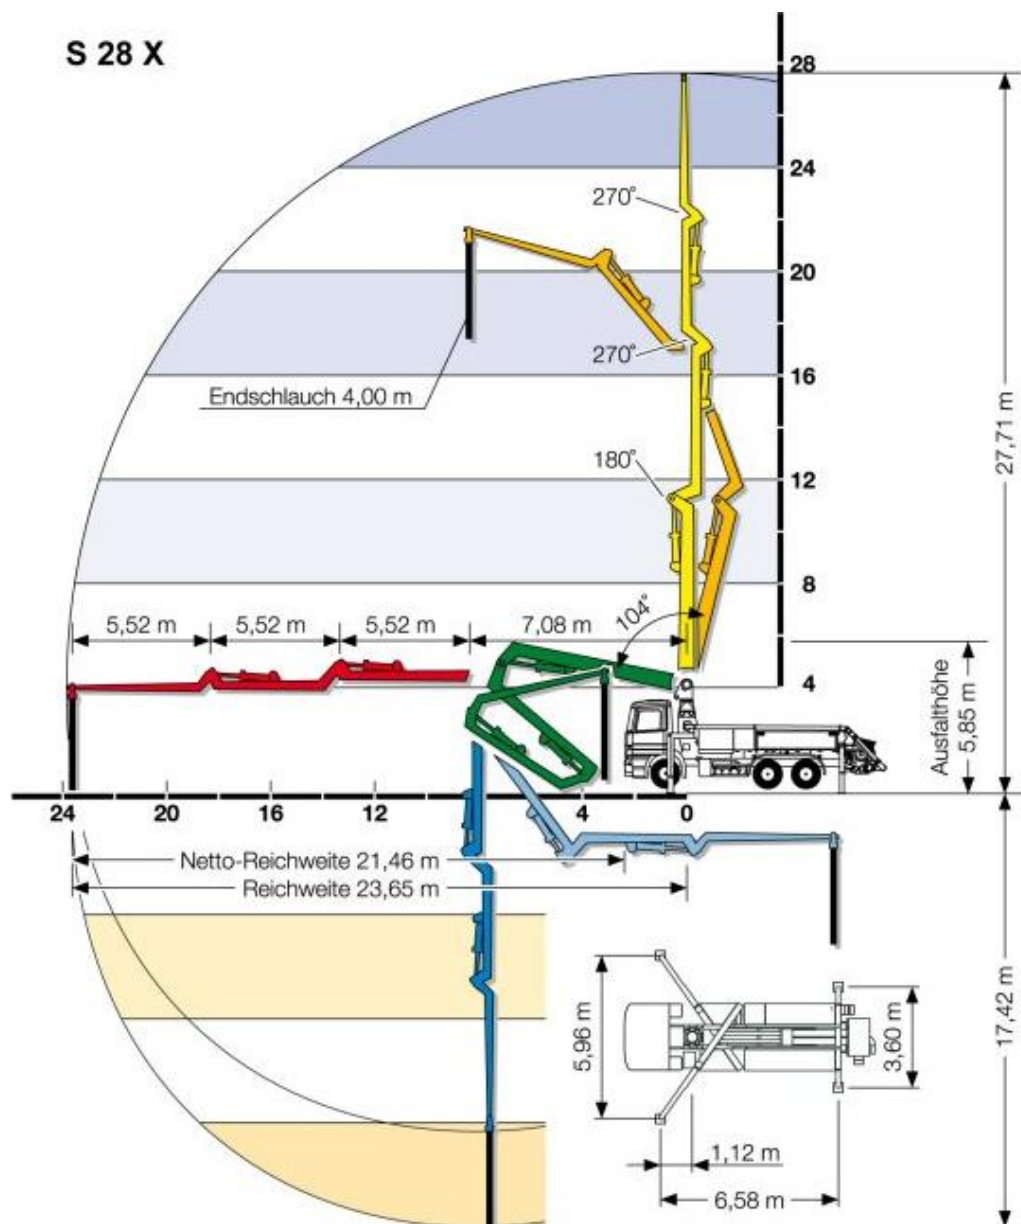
Čerpadlo na beton SCHWING S 28 X
